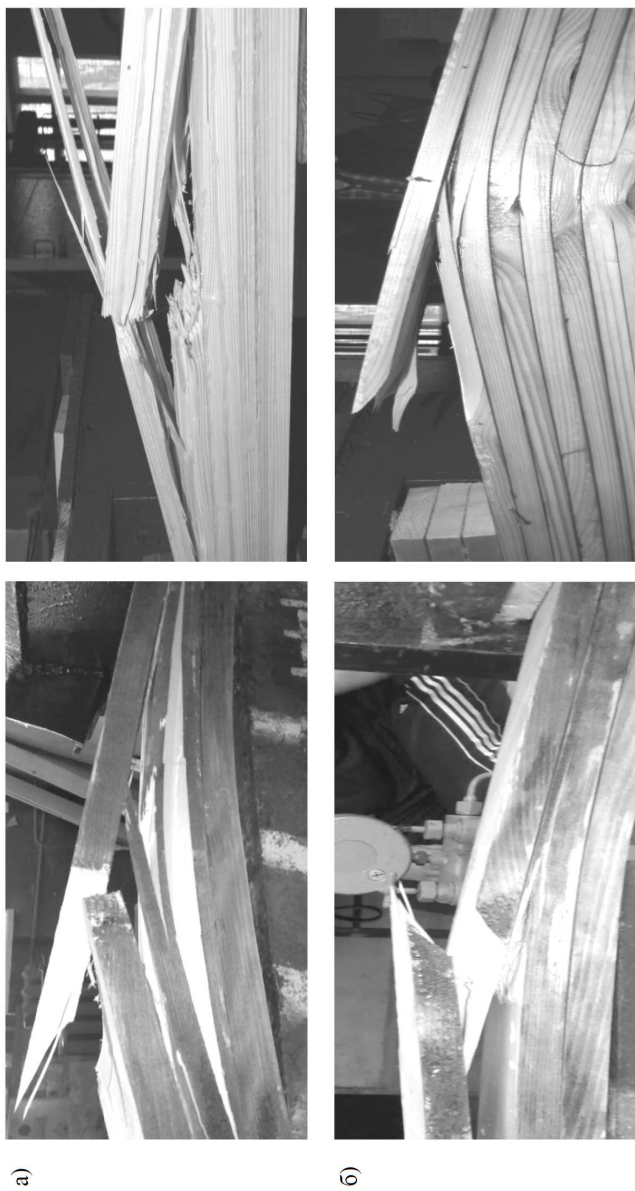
Характер развития трещин: а – клееная деревянная балка без армирования; б – клееная деревянная балка с послойным армированием для препятствия развития трещин
